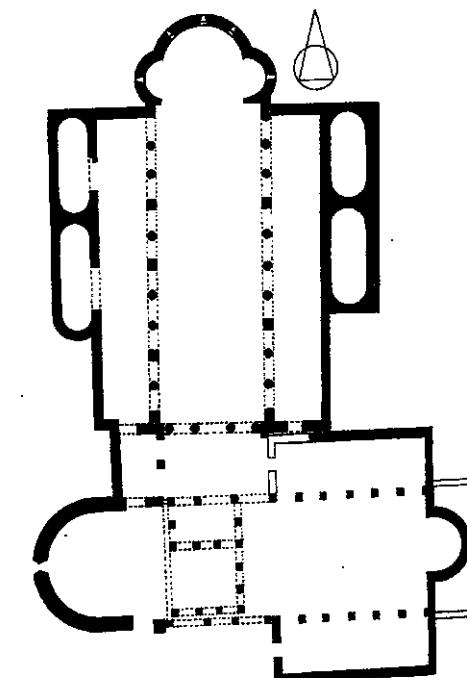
Grundriss des Pilgerheiligtums in Cimitile-Nola
